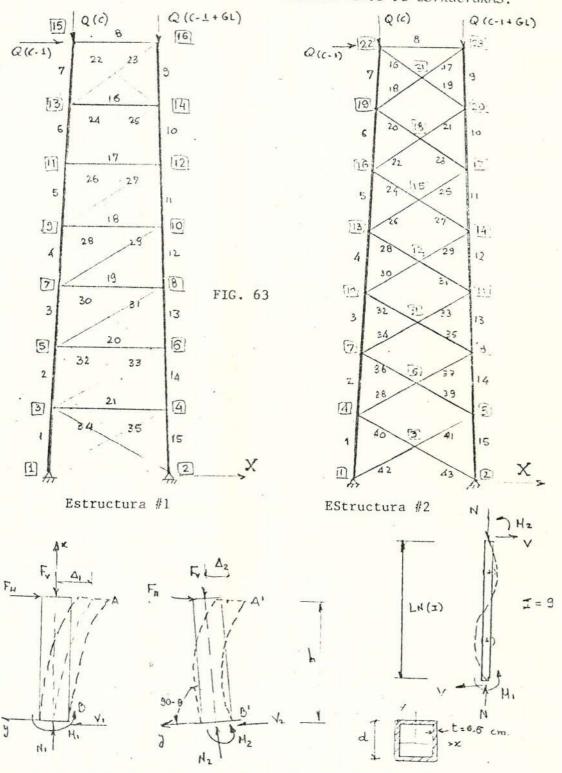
,b La inclinación de las columnas tiene sus ventajas
